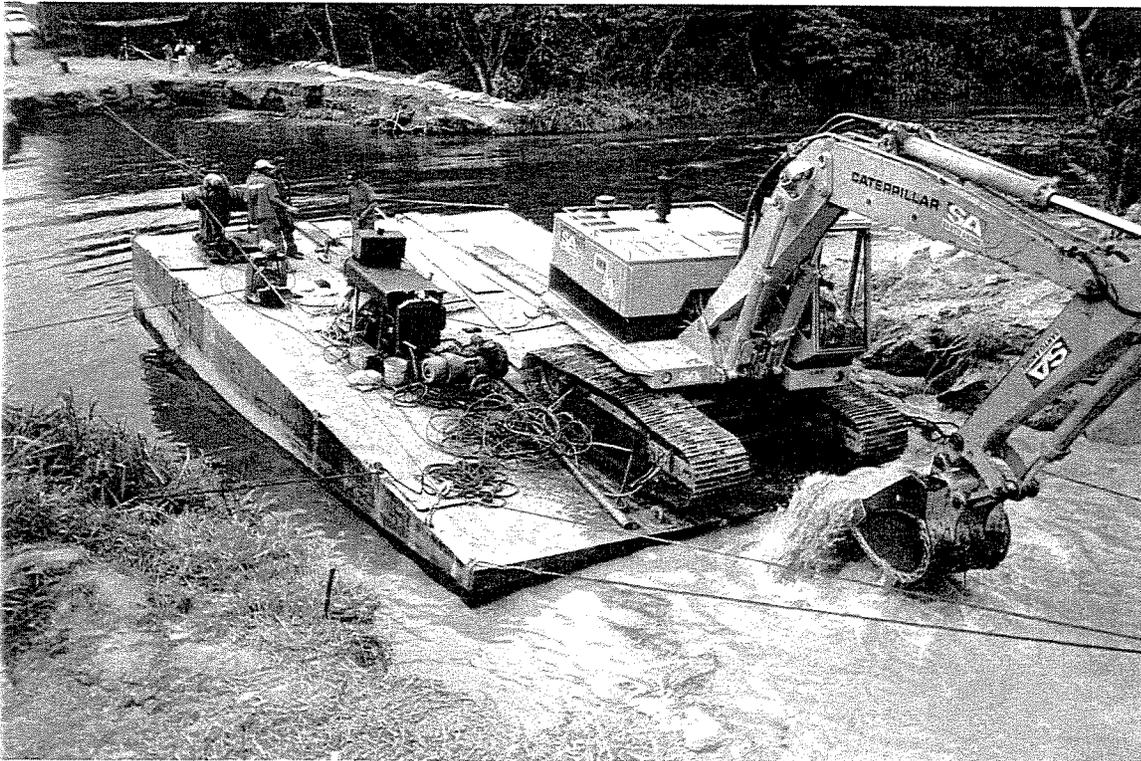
ESCAVAÇÃO COM BALÇAS
